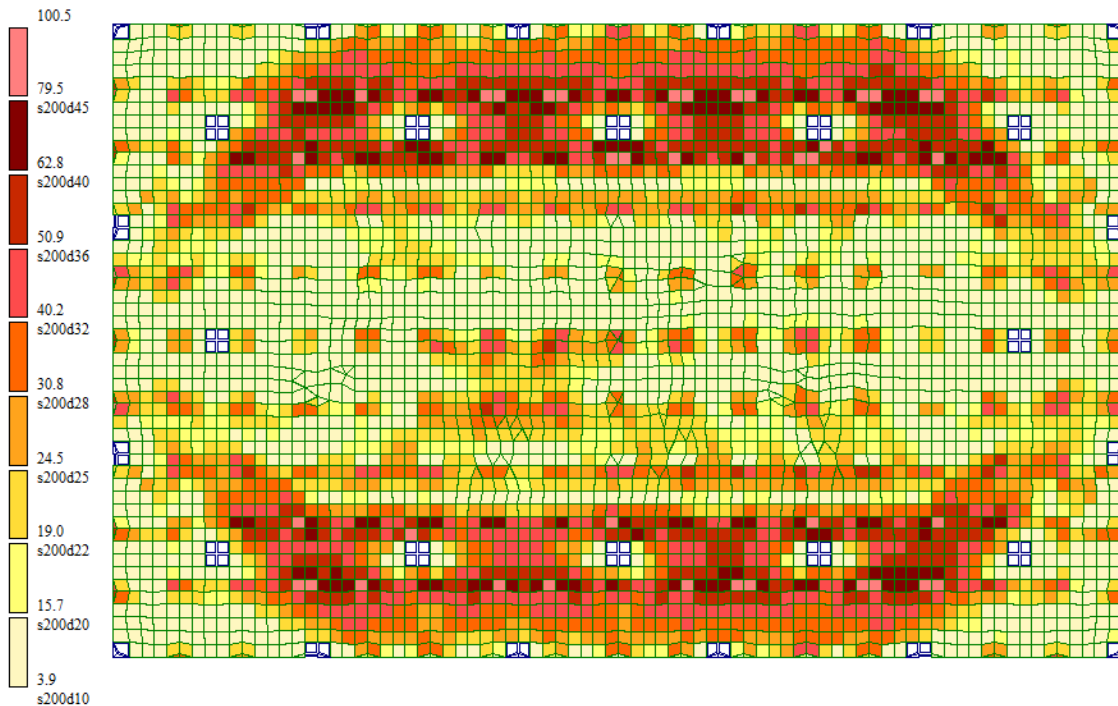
Схема армирования верха фундаментной плиты по оси OY
